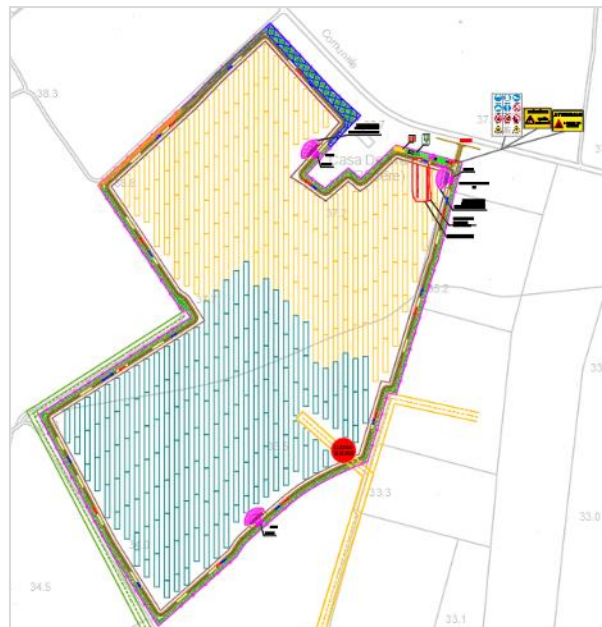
Layout di cantiere - Area a nord ed Area a sud
